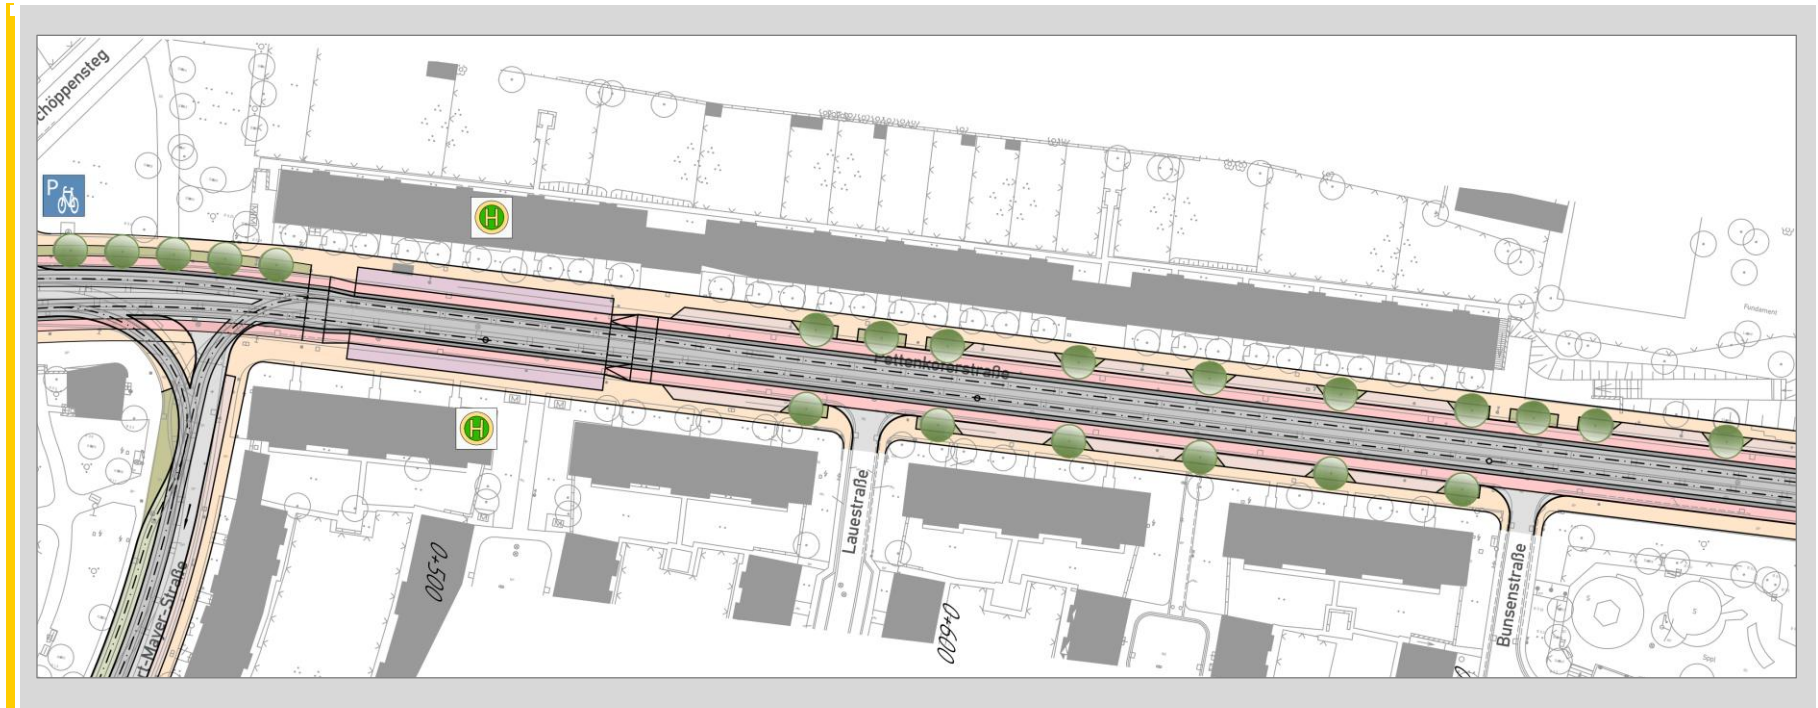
Ausschnitt Lageplan Ausbauvariante 1 Pettenkofer Straße
